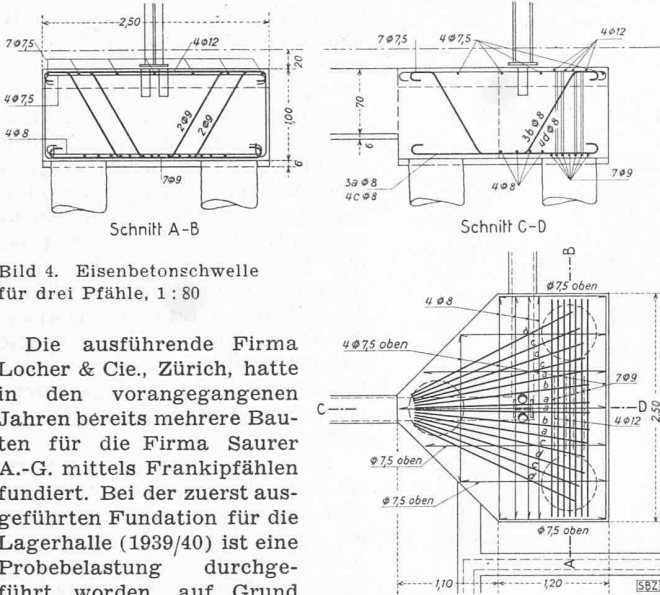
Eisenbetonschwelle für drei Pfähle, 1 : 80
